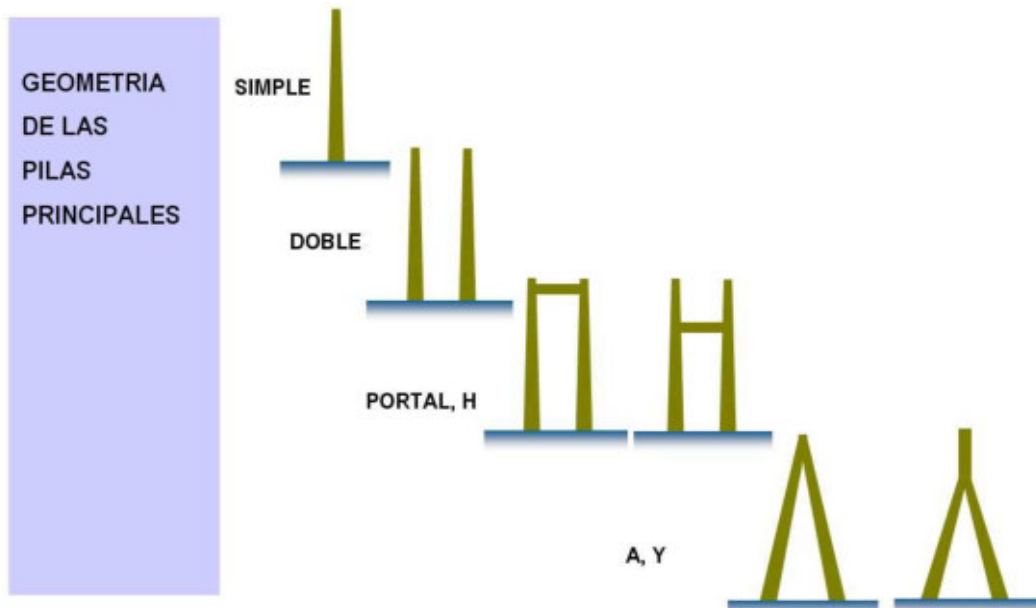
Puente Colgante: Geometría de las Pilas Principales.
